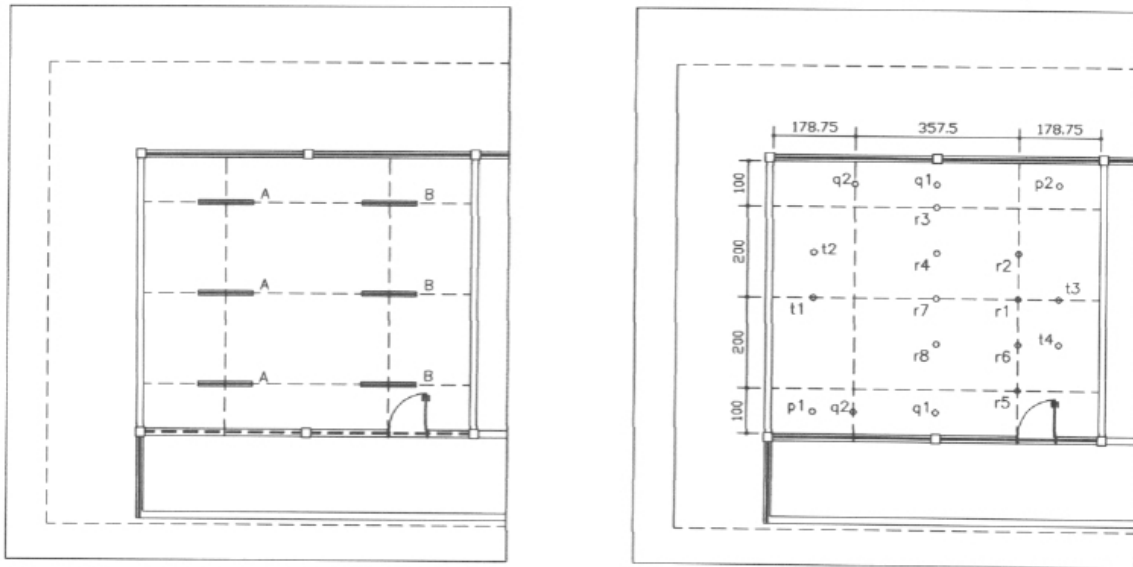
Planta Luminotécnica da sala 03 e localização dos pontos de medição.
